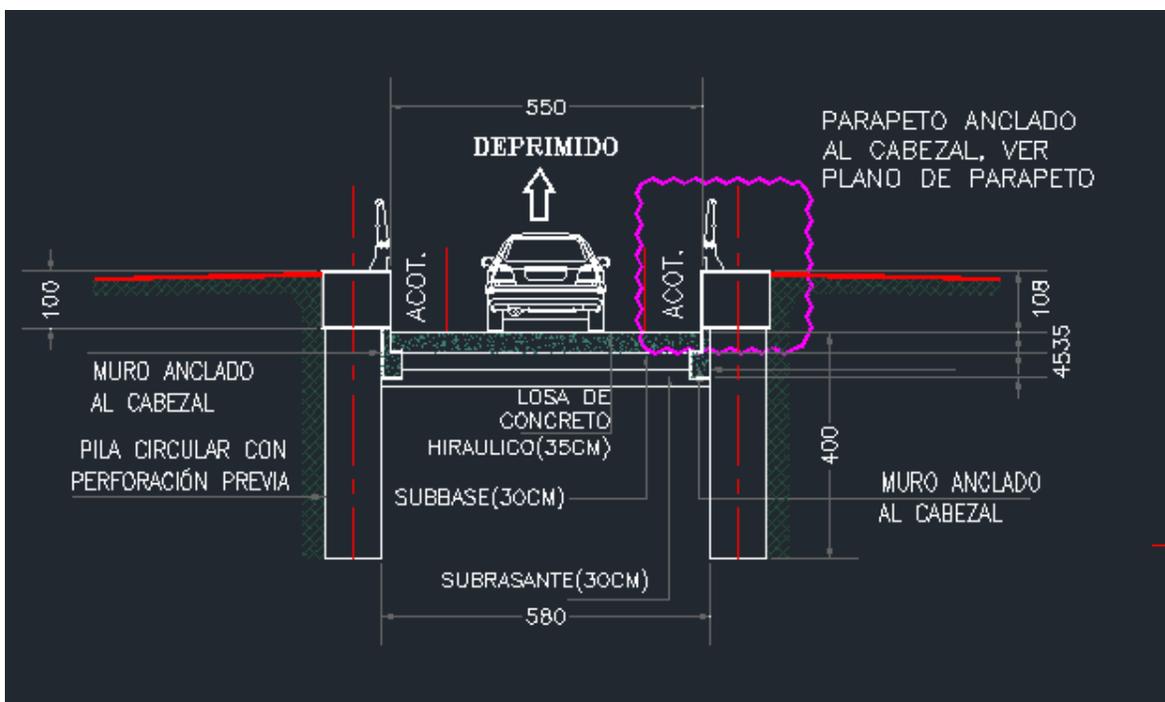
Sección transversal 0+220 a 0+260 (incorporación Carr. Méx. 15).
